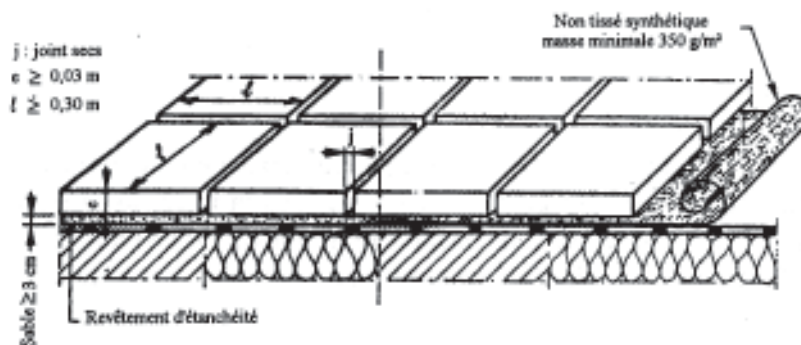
Protection de toitures terrasses techniques par dalles préfabriquées
